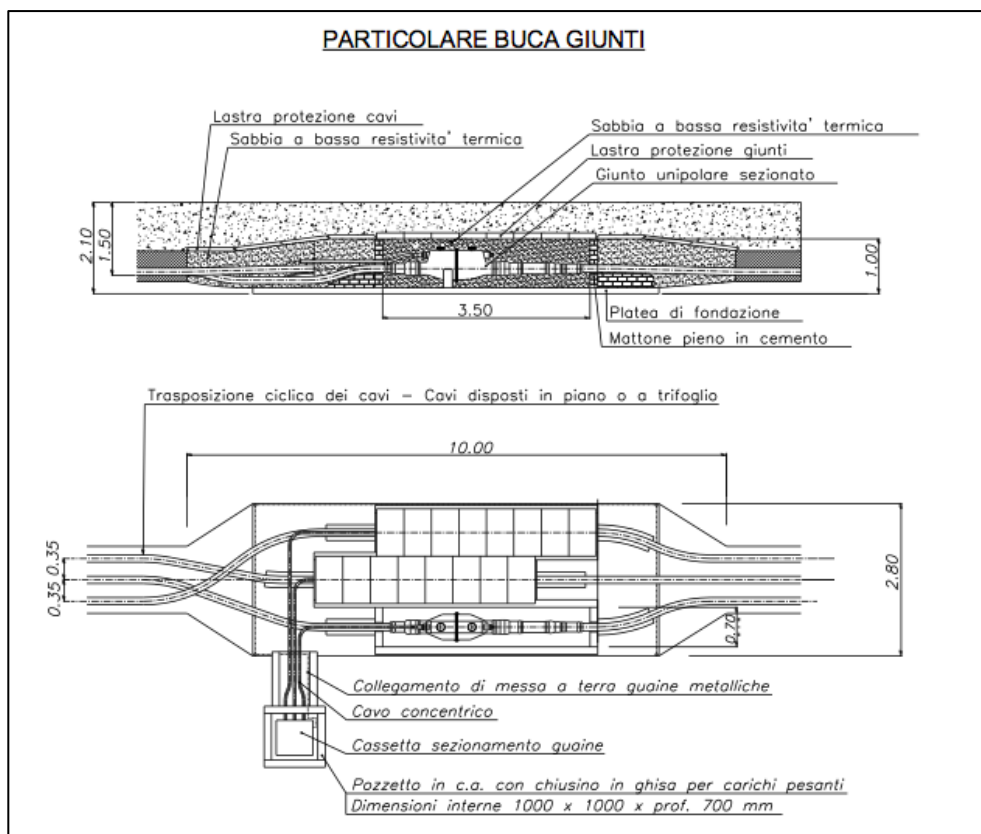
Tipo Camera Giunti: Sezione e Pianta
